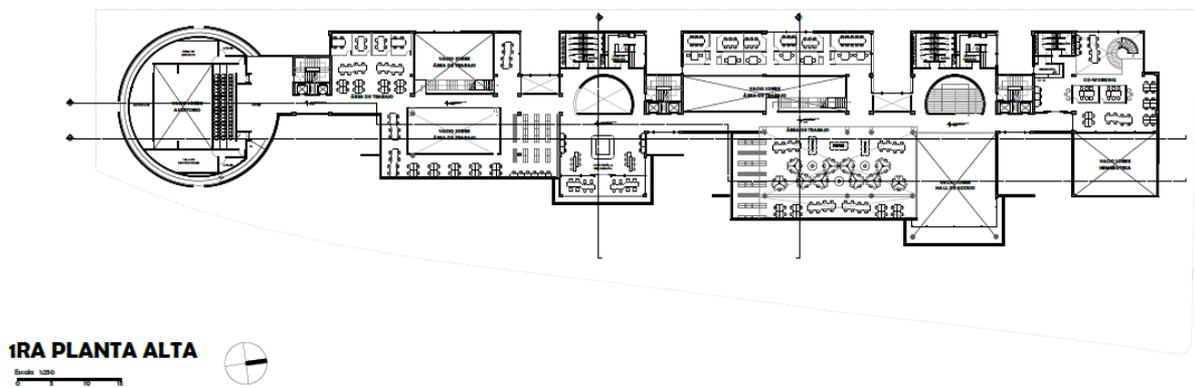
Primera Planta Alta CRAI. Elaboración Propia.
